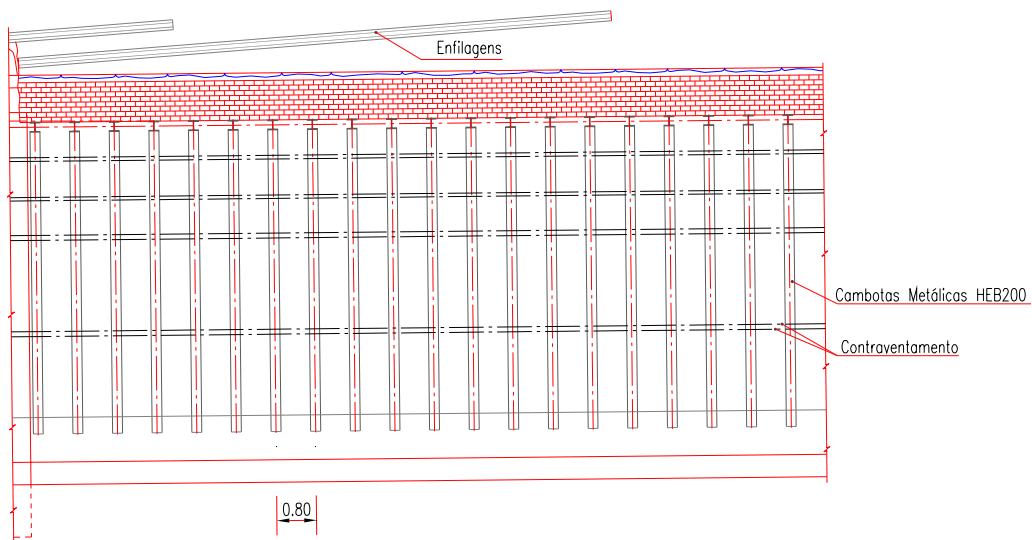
Corte longitudinal de uma secção do túnel [17]
